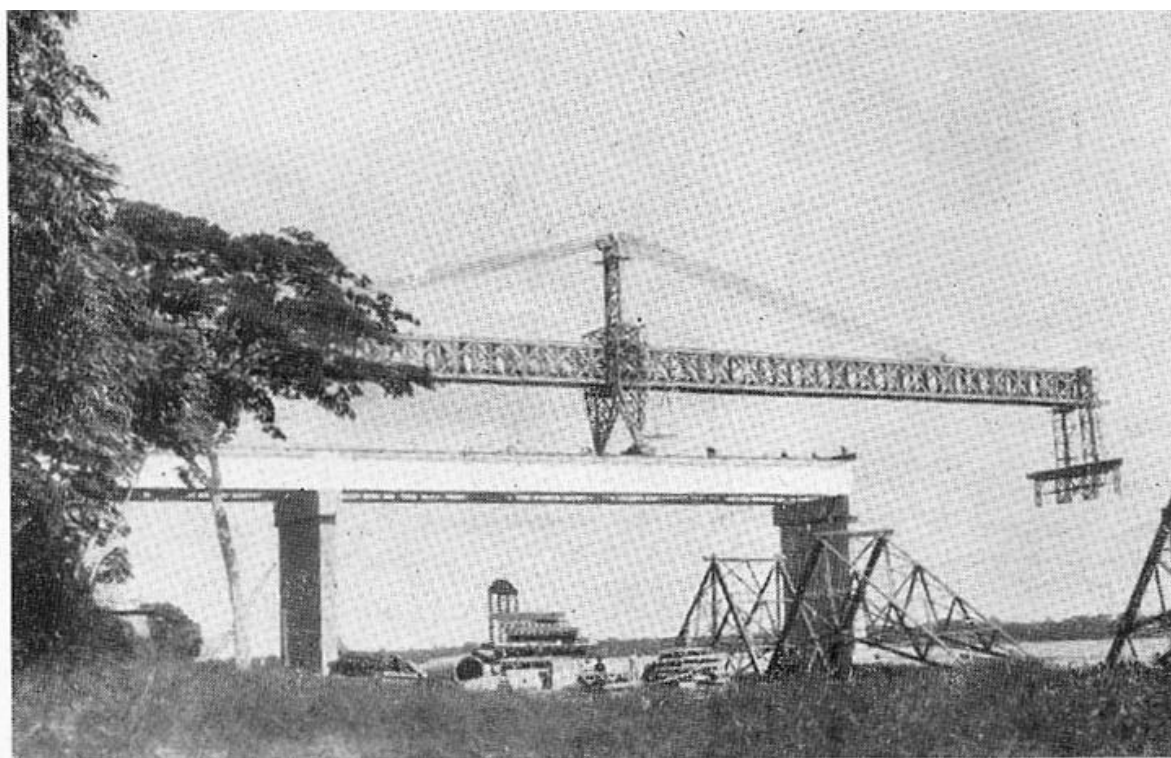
Deslocamento de treliça de lançamento das vigas de 45 m. Vista durante o transporte
